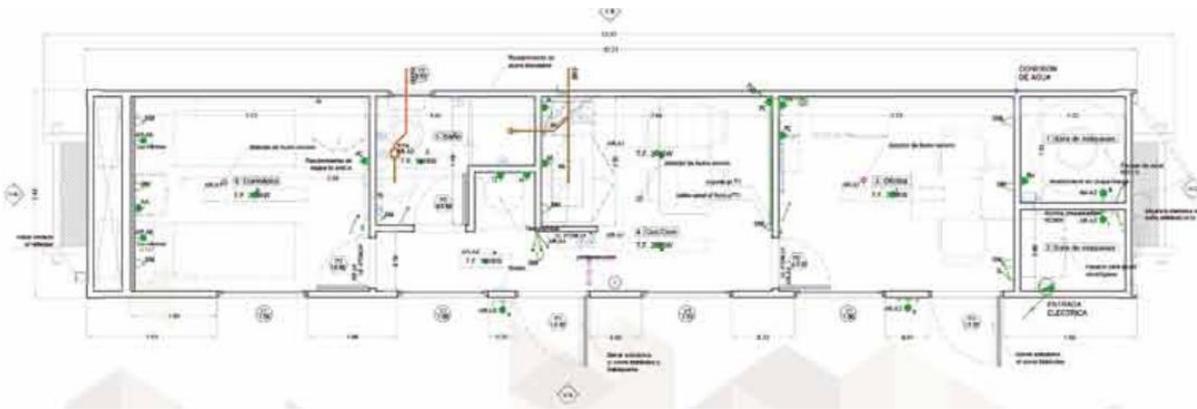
Plano tráiler vivienda. Fuente: Andariega.
